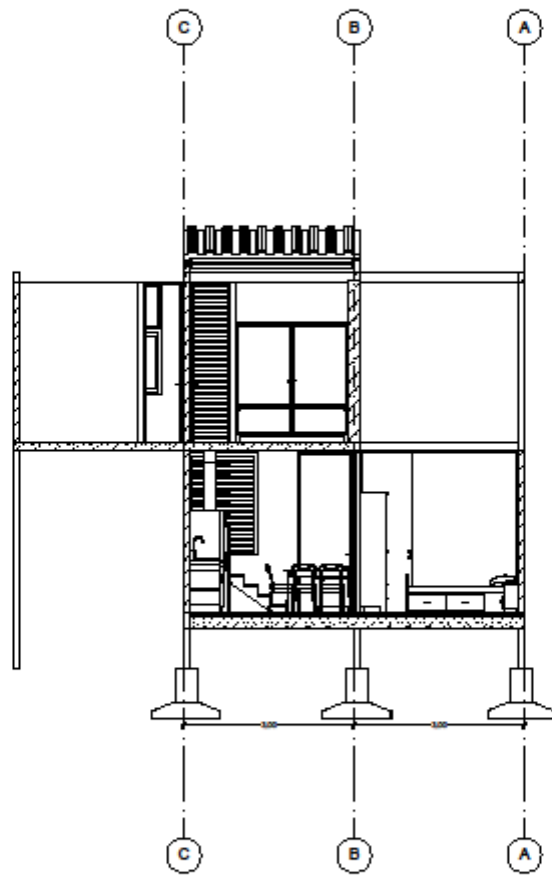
Tipo A. Corte Transversal. Esc.: 1:100
